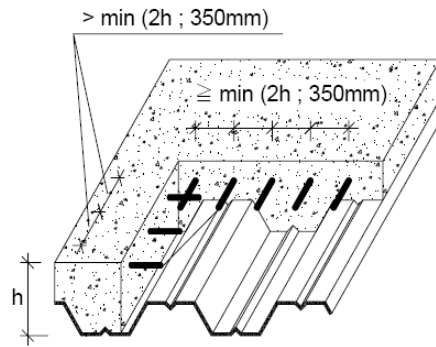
Área da armadura. (“Lajes mistas,” n.d.)
